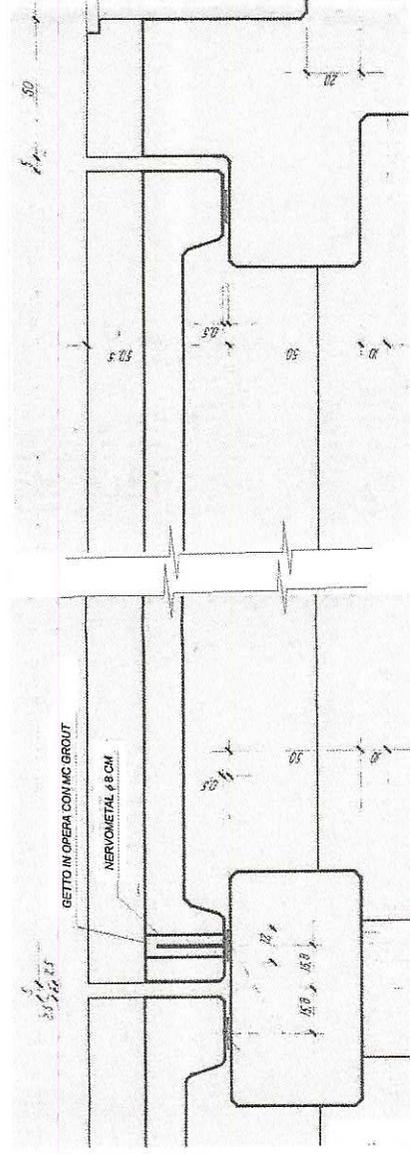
Modalità di vincolo dell'elemento pontile sui traversi. A sinistra appoggio fisso, a destra appoggio mobile.
